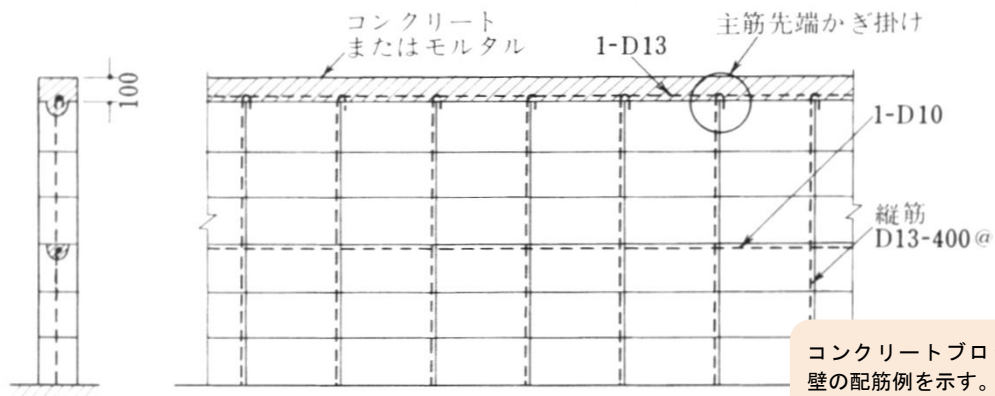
コンクリートブロック小壁等の配筋例⁴⁵
